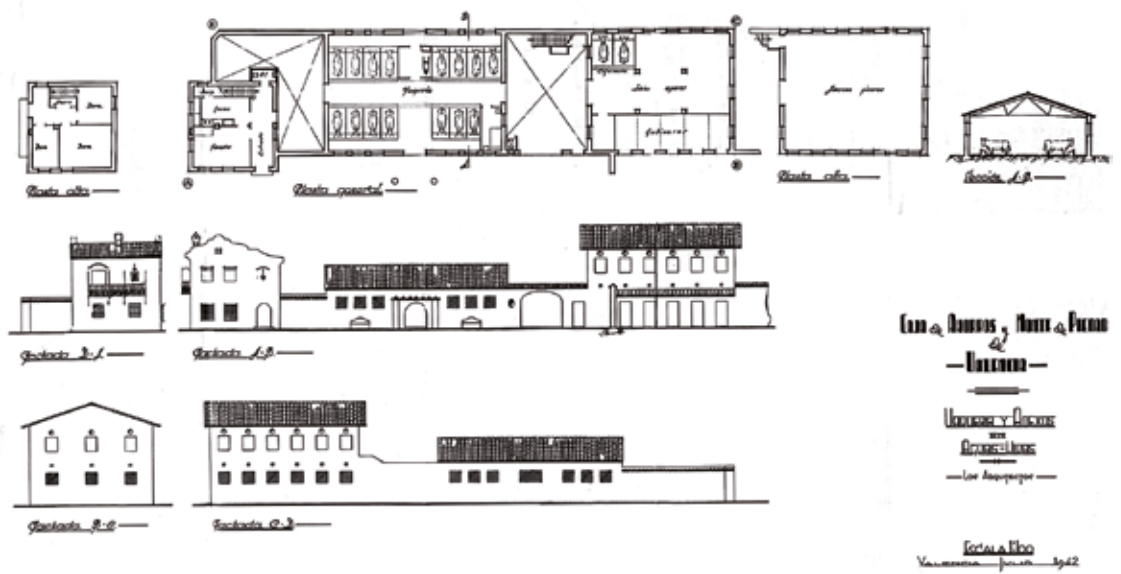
/ Planta y alzados Vaquería y vivienda aneja, julio de 1942.
